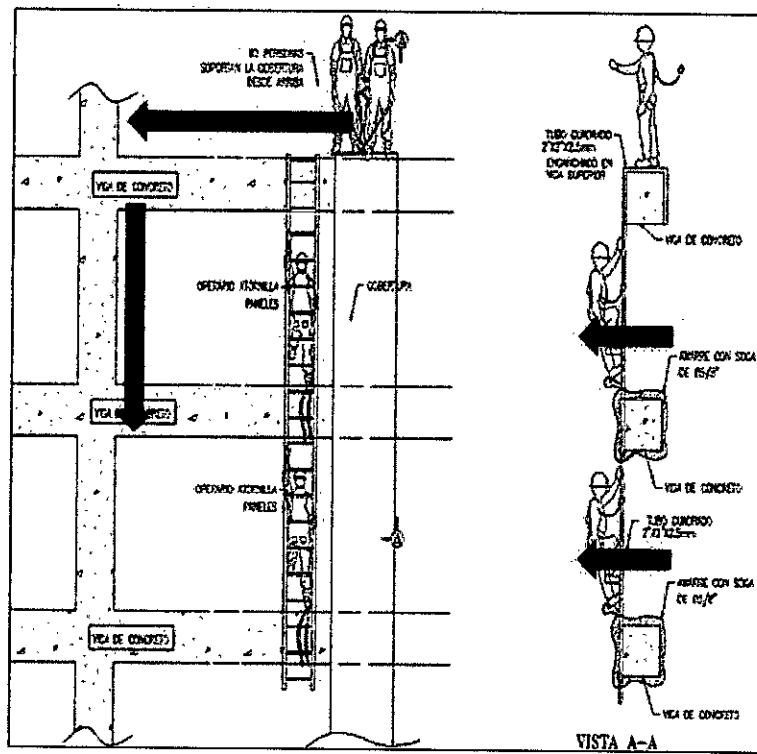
Instrucción de retiro de paneles de techo deteriorados.
